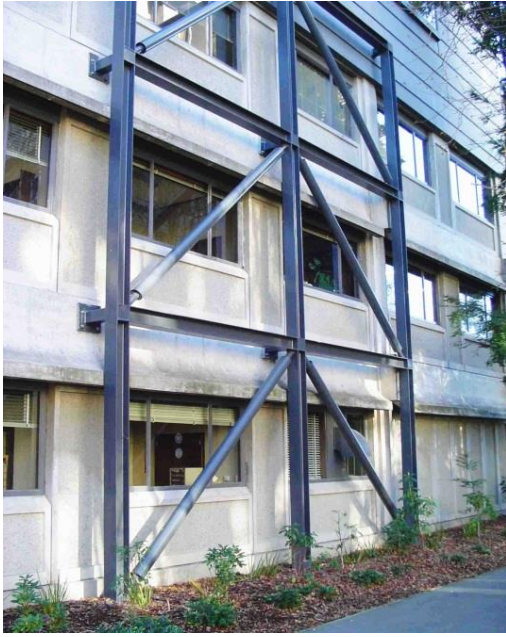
Vista de un pórtico arriostrado de acero utilizado para la rehabilitación de una estructura existente de hormigón armado.
